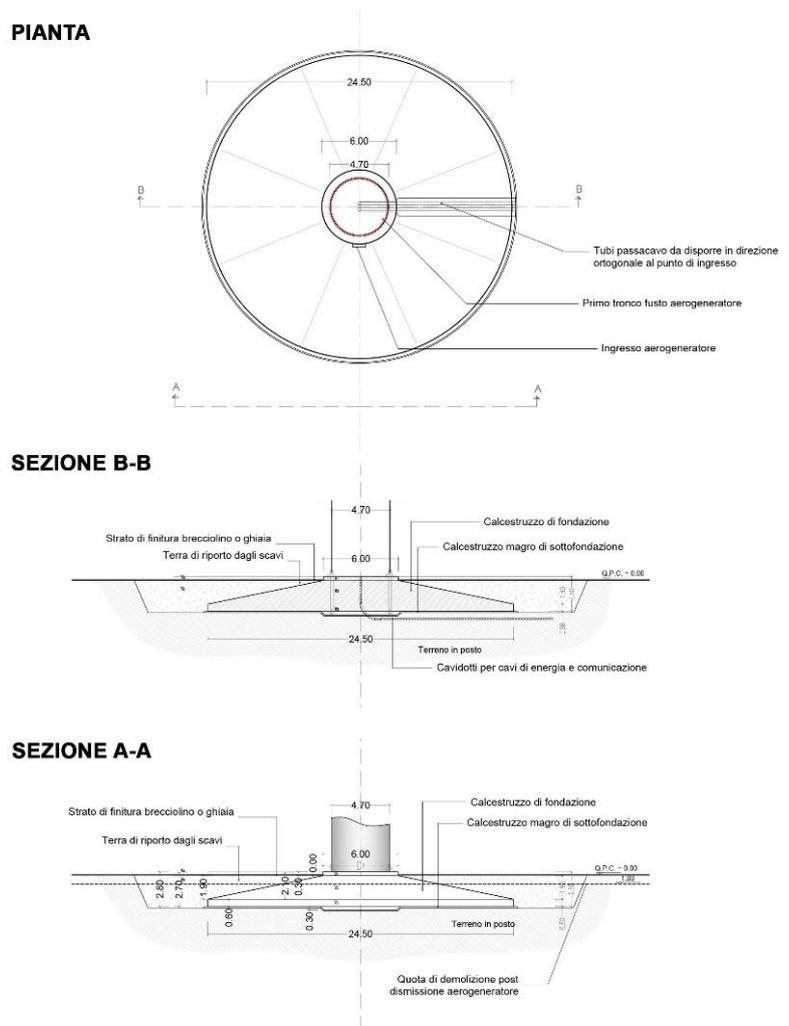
Pianta e vista della fondazione tipo dell'aerogeneratore
